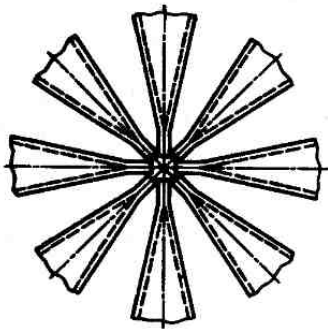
Сварная решетчатая конструкция со сплюснутыми на концах трубами
